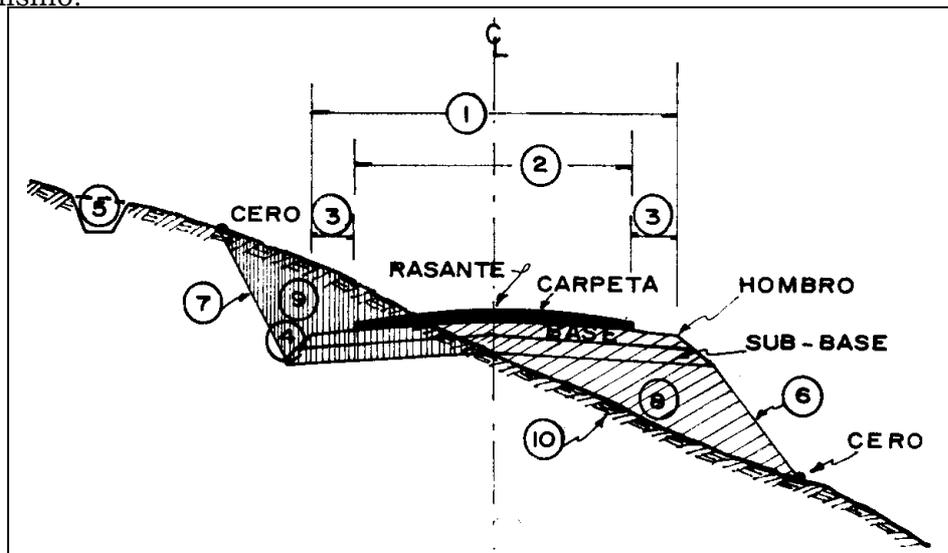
SECCIÓN TRANSVERSAL TÍPICA EN TANGENTE DE UN CAMINO
